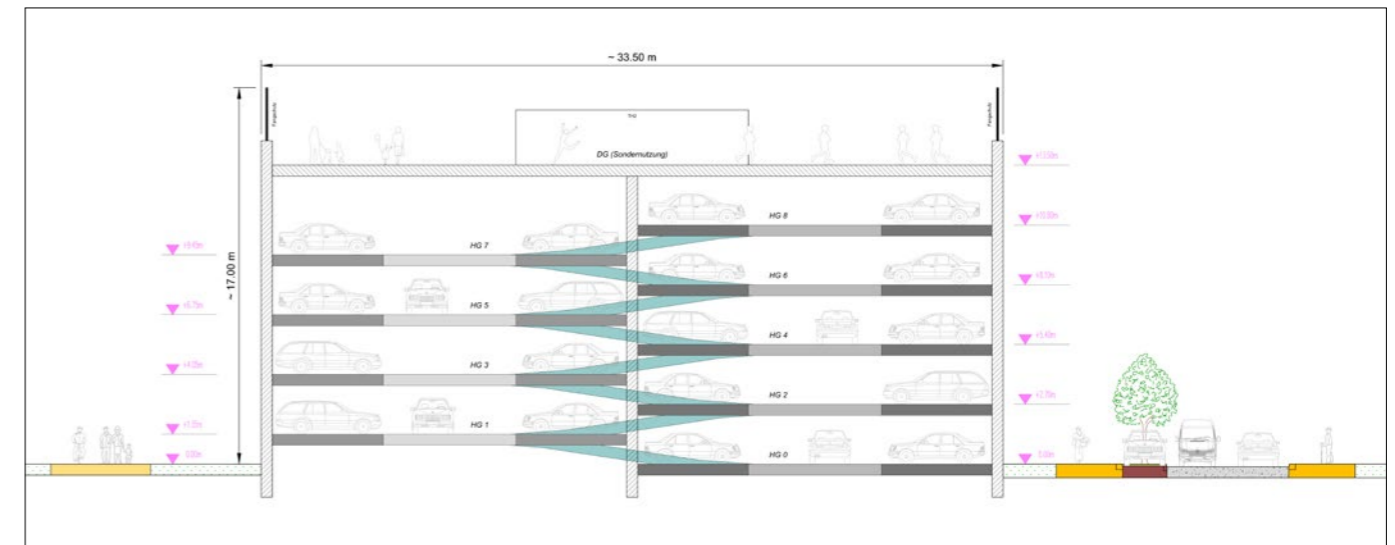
Schnittskizze einer Bewohnersammelgarage mit Freizeiteinrichtung auf dem Dachgeschoss
